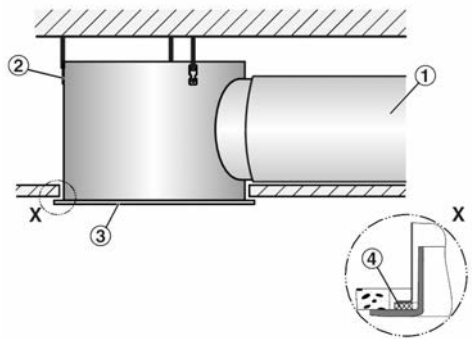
Deckenbündiger Einbau mit rundem Anschlusskasten
